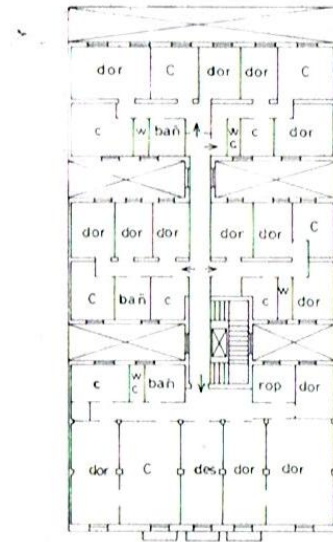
Edificio de viviendas en el Ensanche sur , C/ Murcia. 1935
